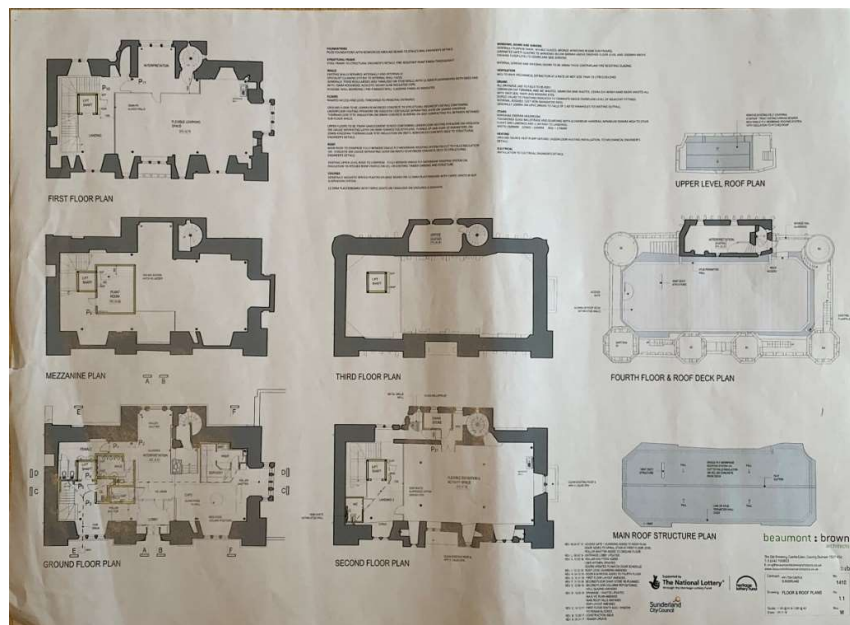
Castello di Hylton: progetto di rifunzionalizzazione (archivio Hylton Castle Trust)
